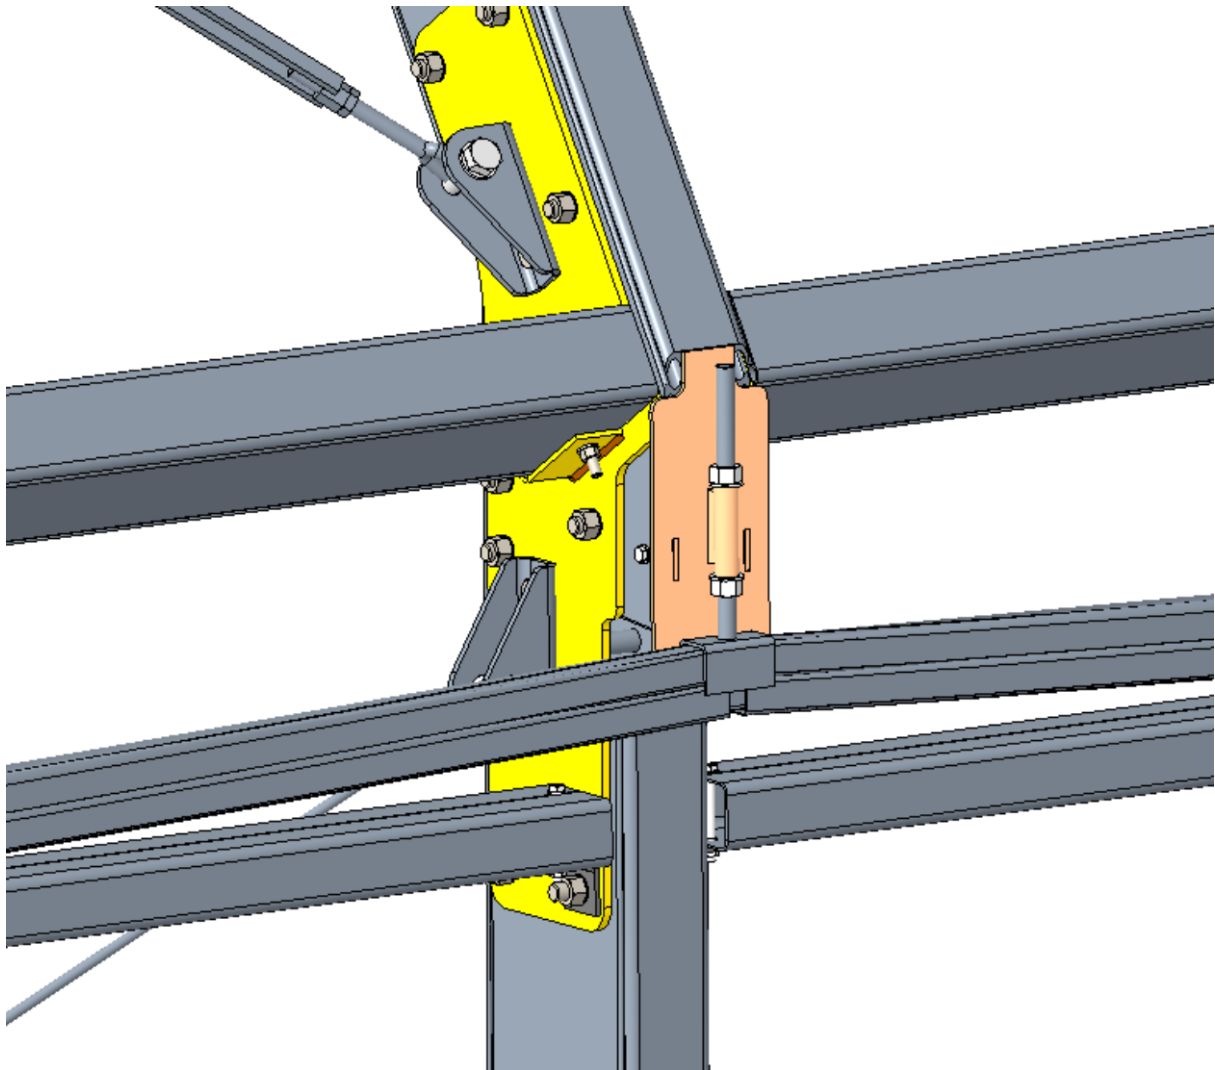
Assemblage poteau ferme + panne sablière et lisse haute
